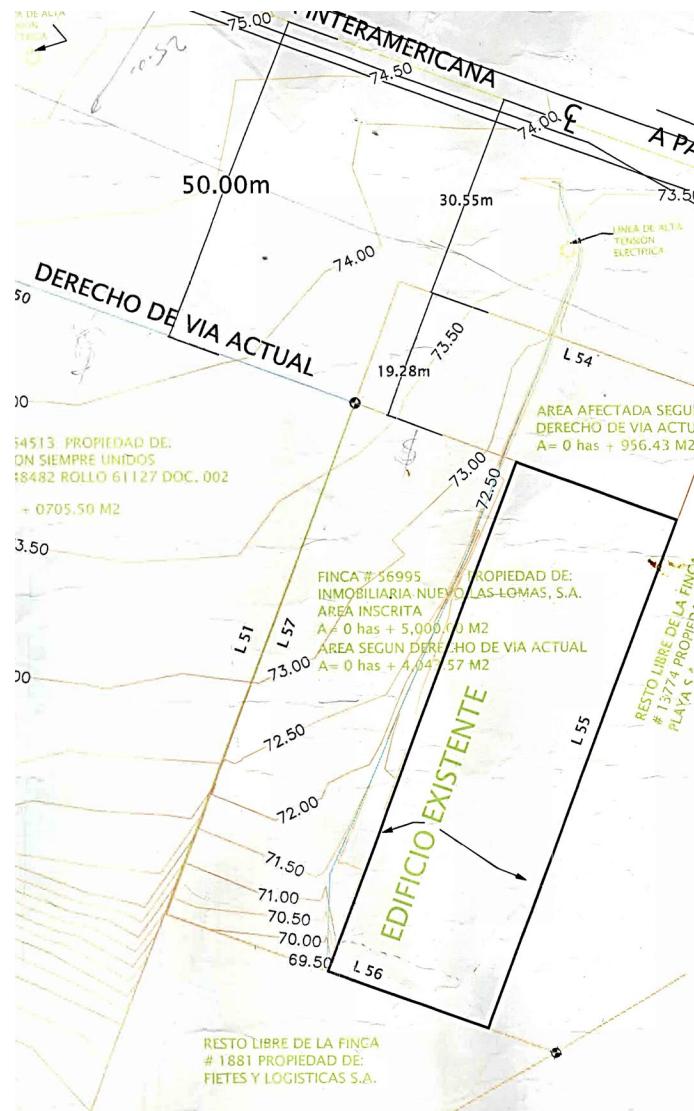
Topografía del terreno donde se desarrollará la galera.
